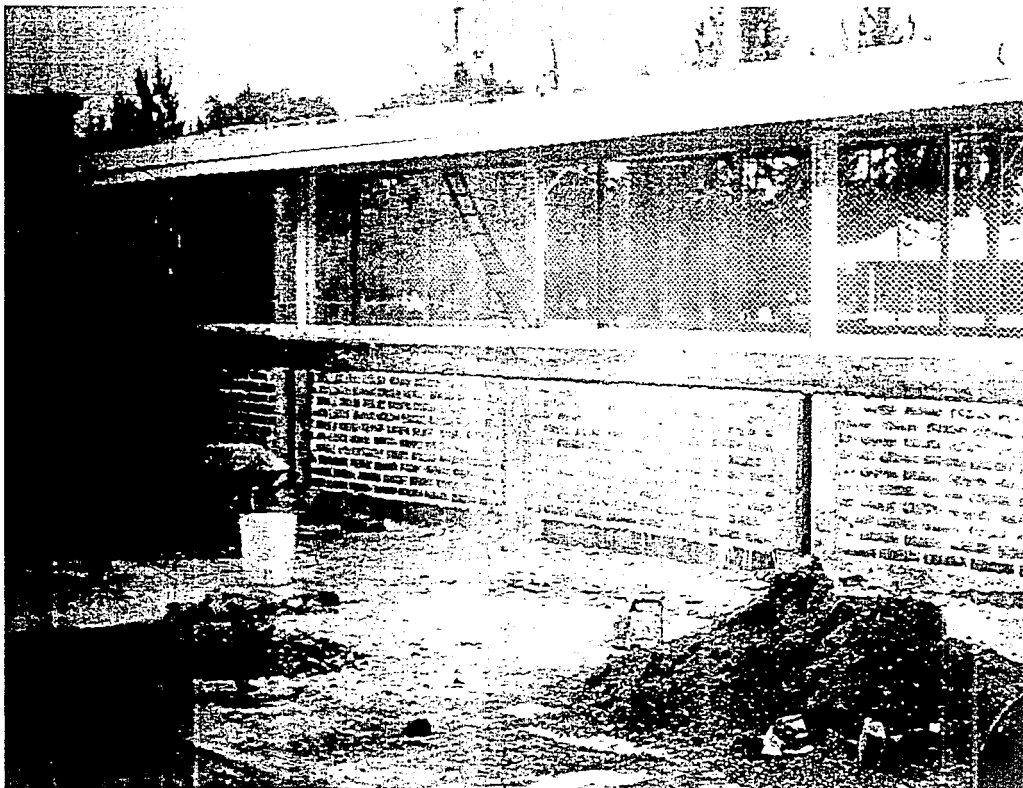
Aplicando el primario para pintar las estructuras metálicas internas de los techos.
